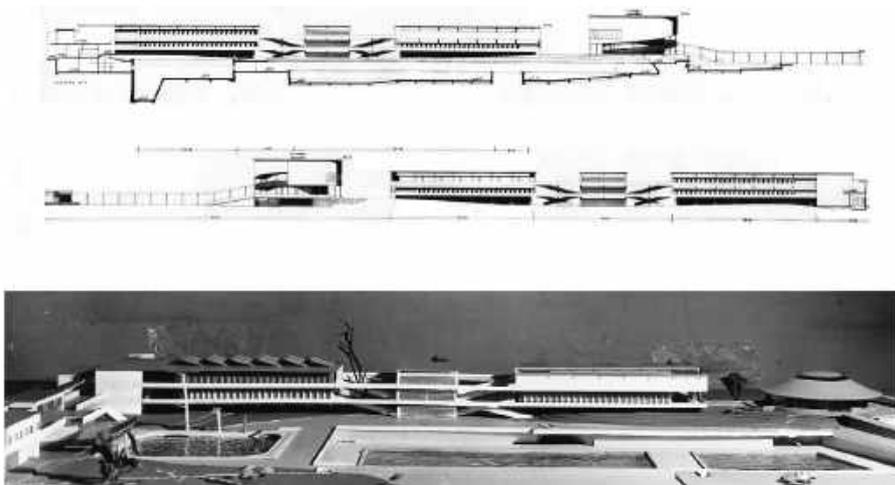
Sezione nord, prospetto nord e plastico di concorso
